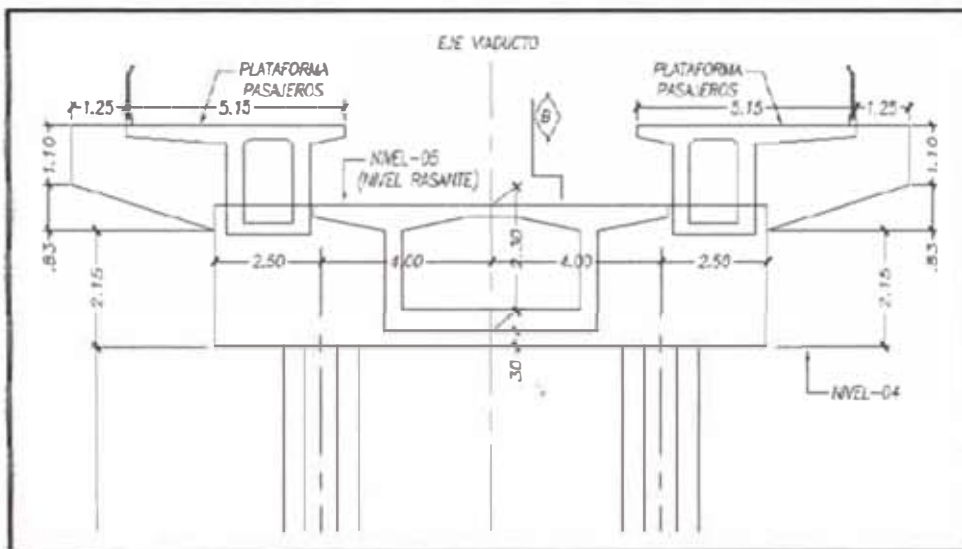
Sección transversal típica de la Viga Cabezal en Pilar S49
